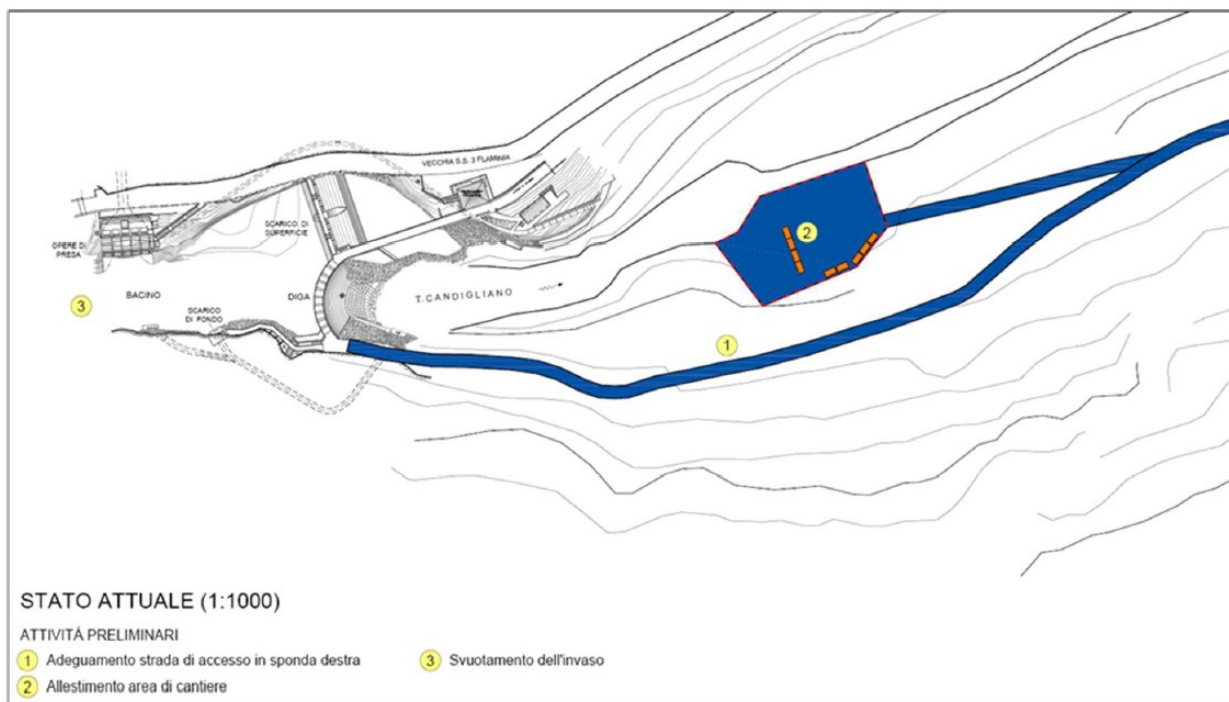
Attività preliminari – allestimento aree di cantiere e adeguamento strada di accesso
